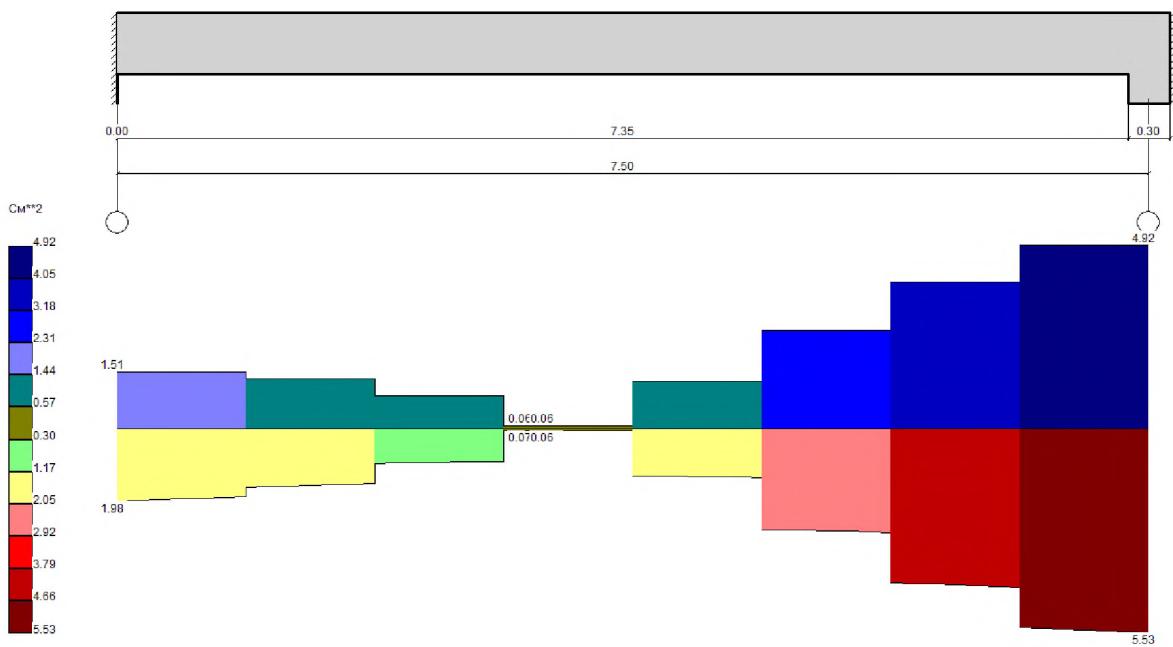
Балка № 1. Епюра поперечного армування
